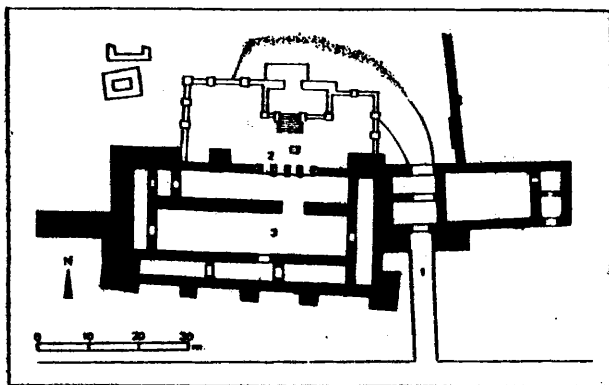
Planta del bit hilani de Tell Halaf, según Lloyd.
